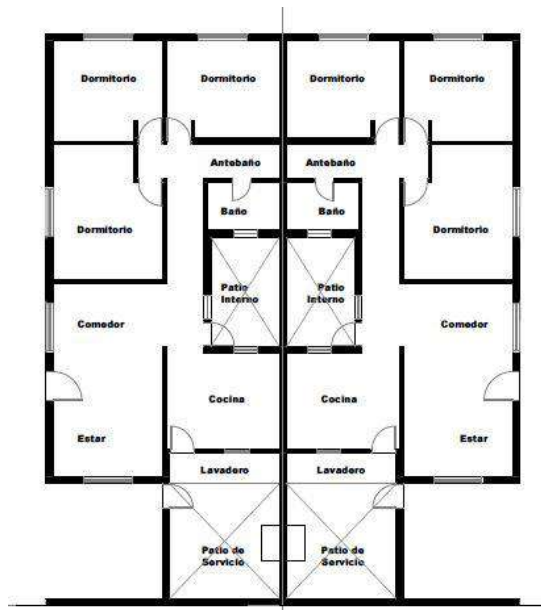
Esquema de planta y volumetría de las viviendas del conjunto estudiado. Fuente: Elaboración propia.
